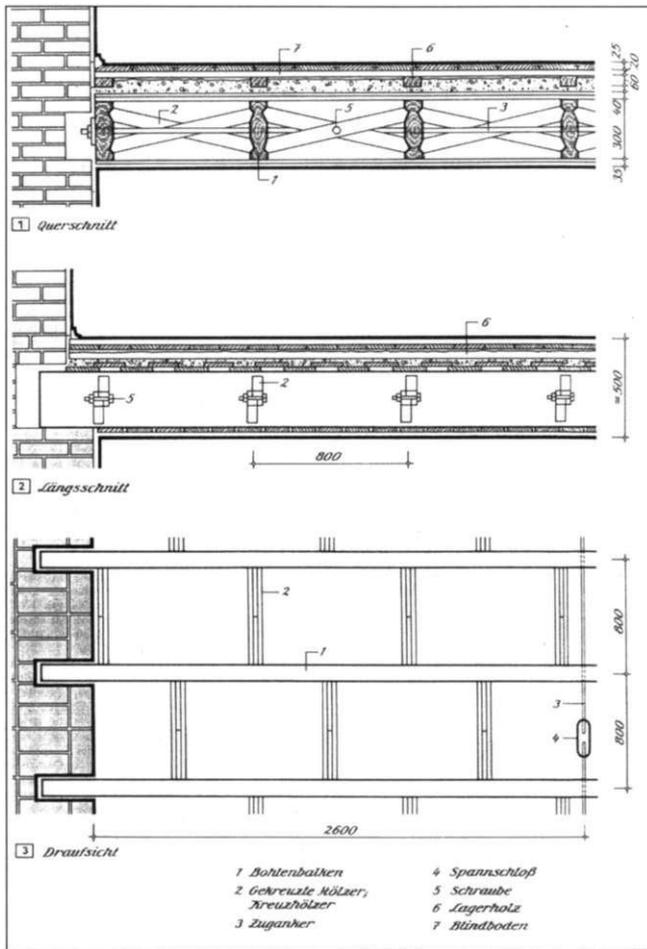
Holzbalkendecke: Bohlenbalkendecke mit Kreuzhölzern um 1900
